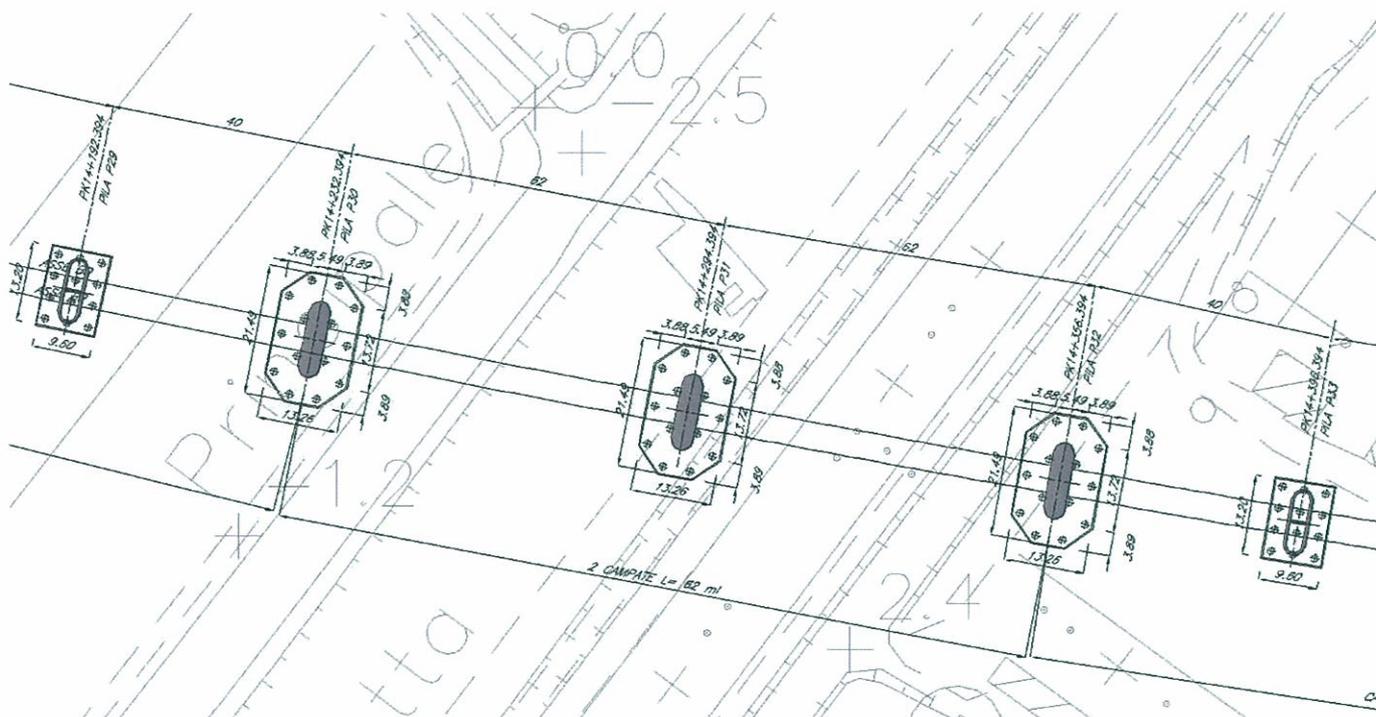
Pianta dell'attraversamento del Canale Fossetta e della S.S. 14 della Venezia Giulia.
